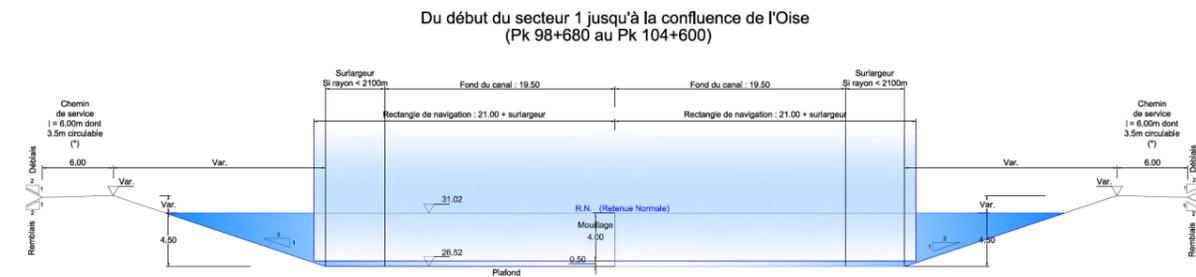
Profil en travers type du canal – début de la section courante du bief de Venette
